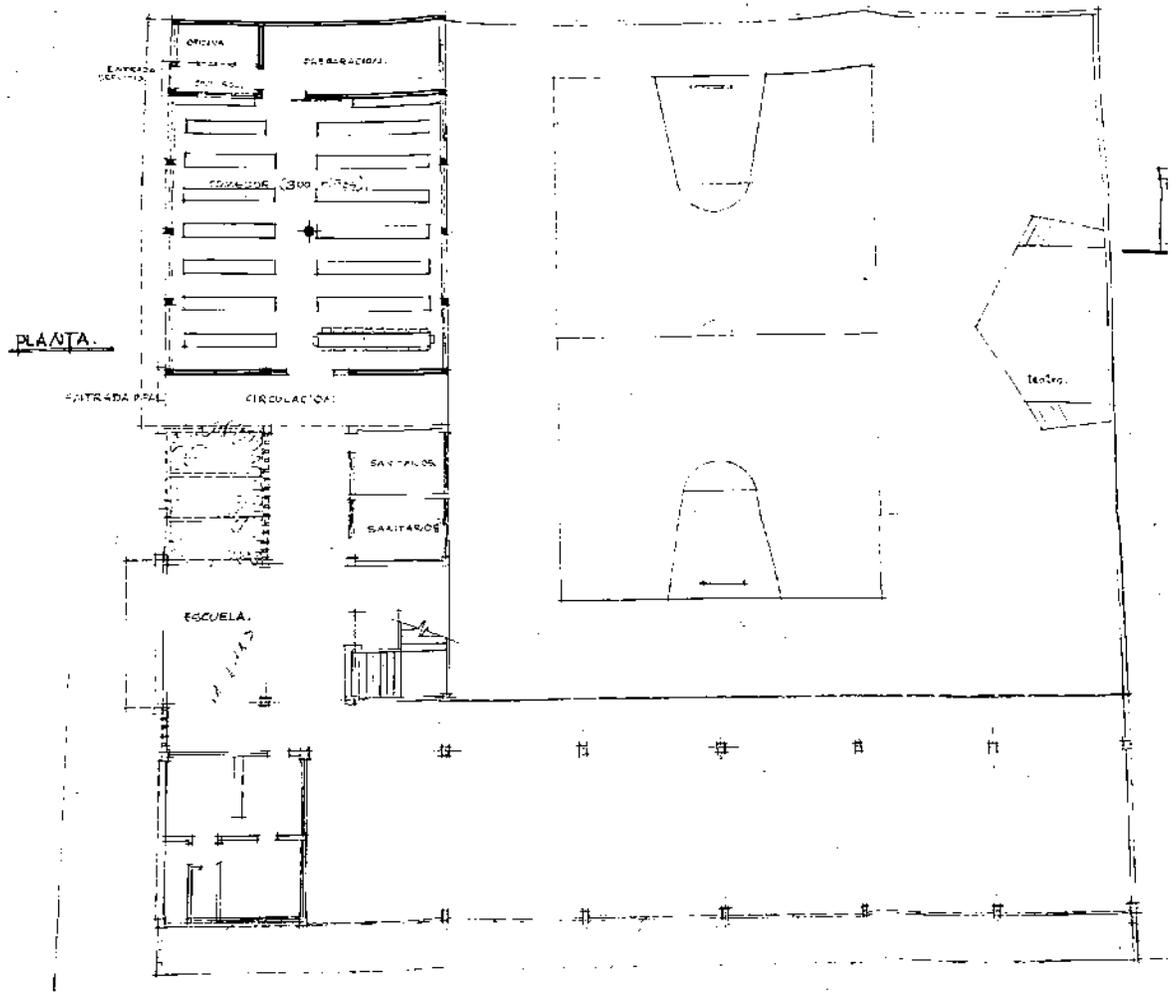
Planimetría 1 escuela Eva Sámano de López Mateos.
